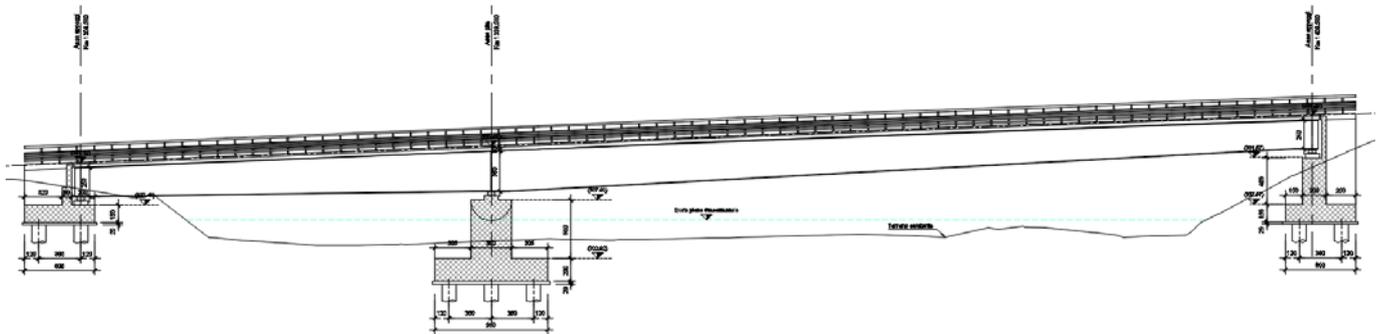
Viadotto Eremita – Sezione longitudinale
